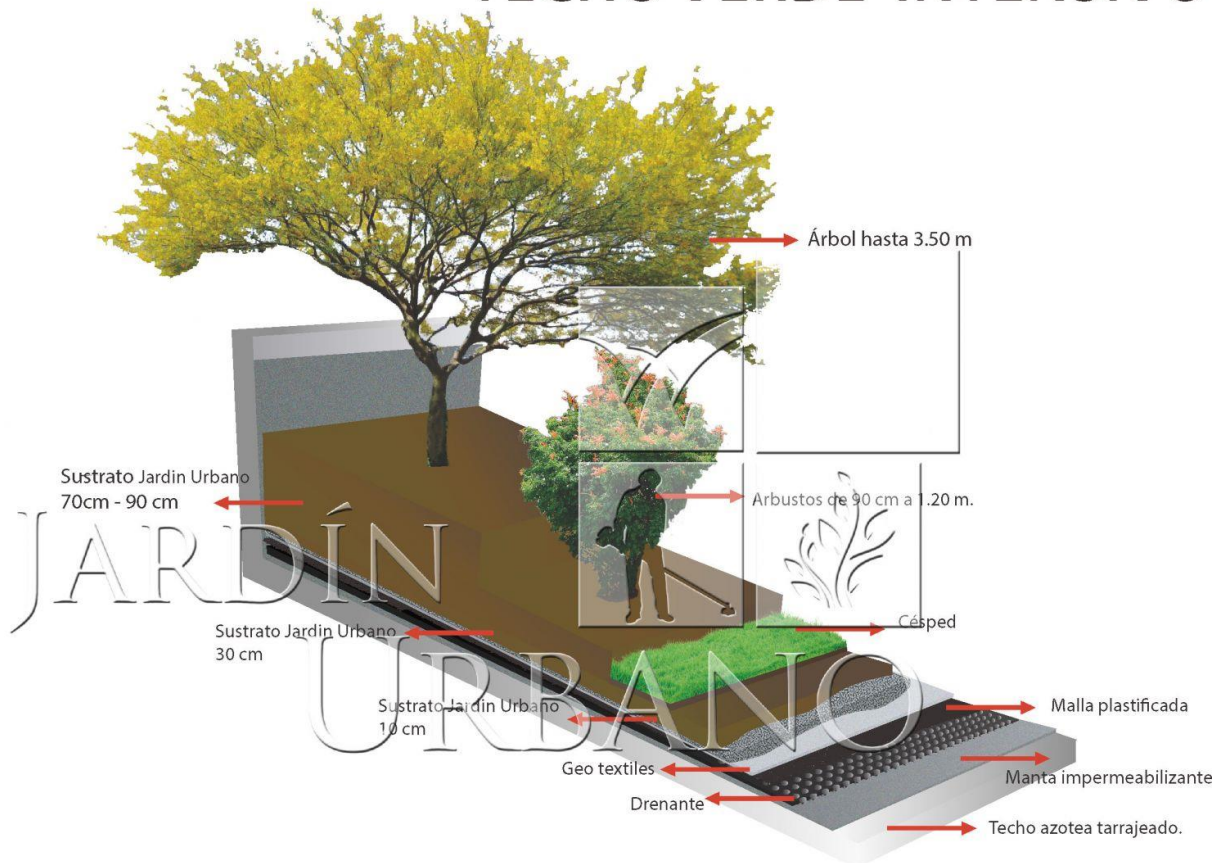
Detalle techo verde intensivo (Fuente: jadinurbano.pe)
